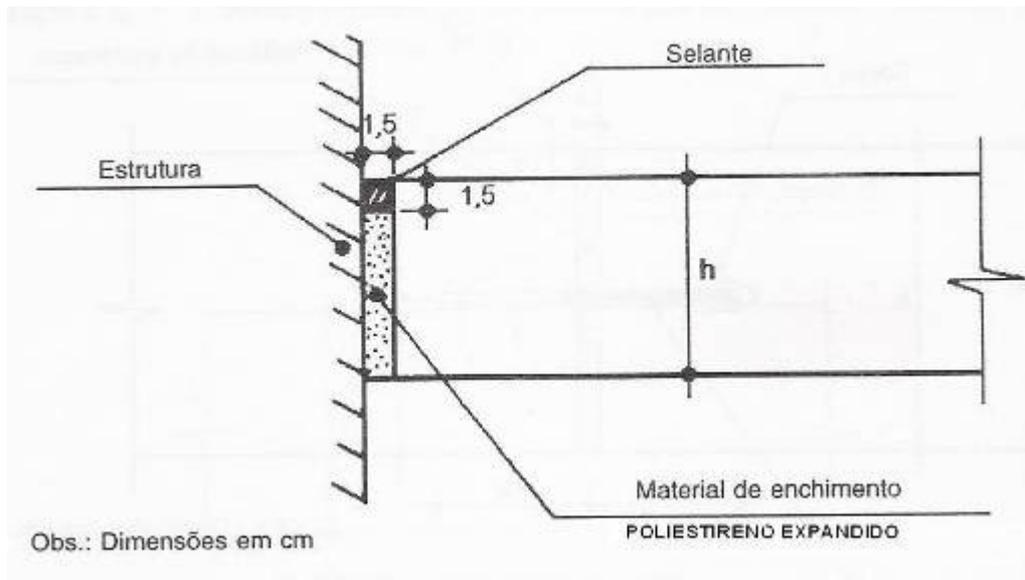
Vista em Corte de Detalhe de Junta de Encontro Periférica (Fonte Carvalho, Pitta 1996)
